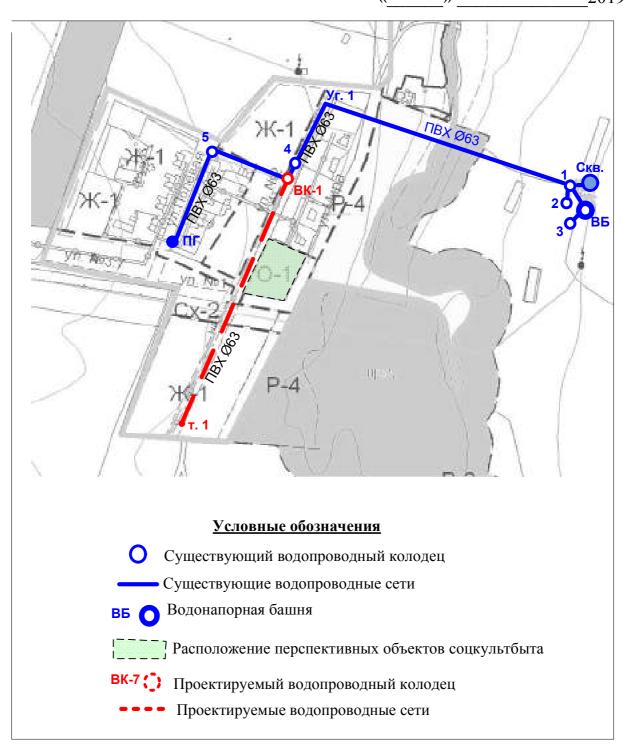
План водопроводных сетей на момент развития схемы водоснабжения п. Каменный Дол
